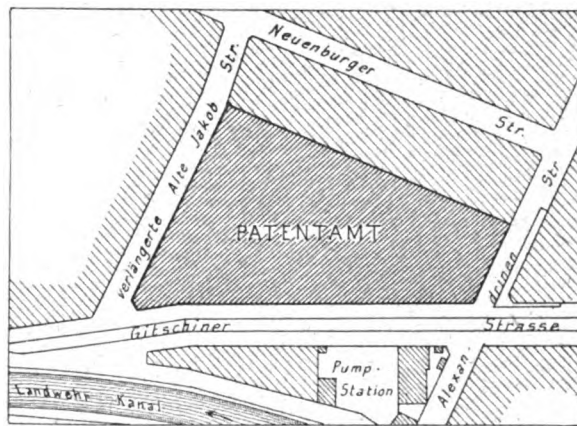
Lageplan für den Neubau des Kaiserl. Patentamtes in Berlin.
